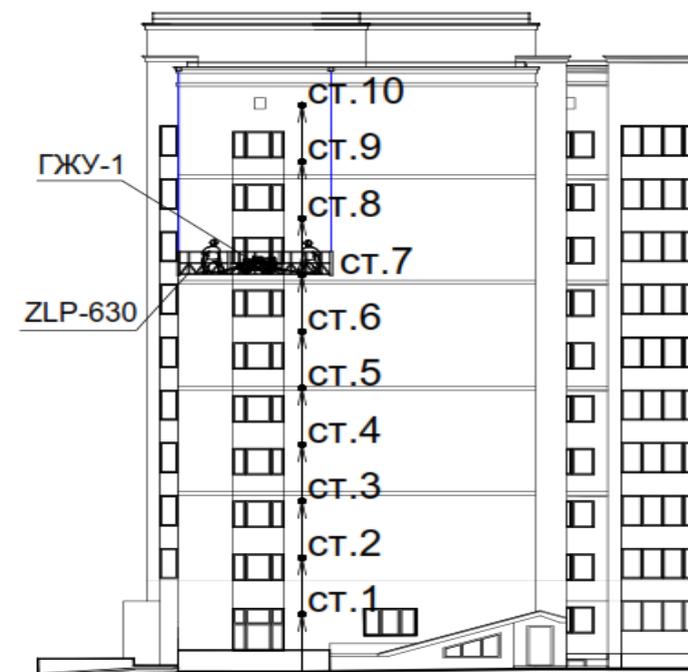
Фасад здания с указанием стоянок подъемника ZLP-630.
